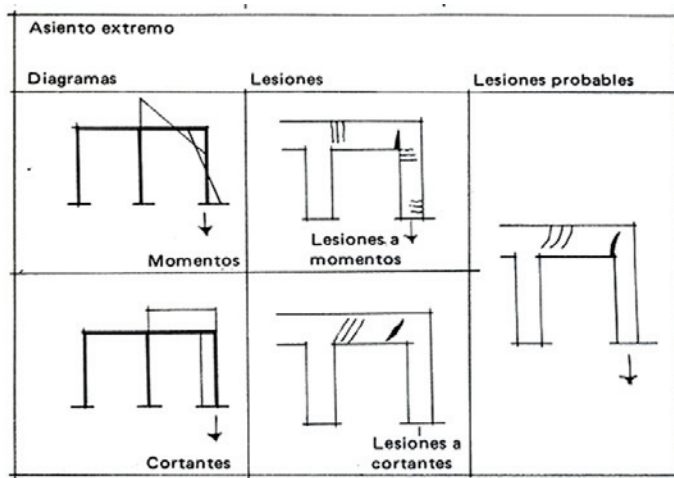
Esfuerzos generados por el movimiento y la situación de las fisuras en un pórtico de hormigón armado de dos vanos en el supuesto de asentamiento extremo.
